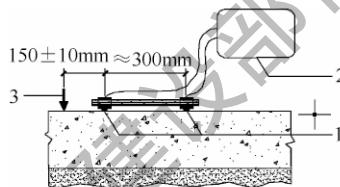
1 冲击回波法测试结构构件混凝土表观波速示意图
